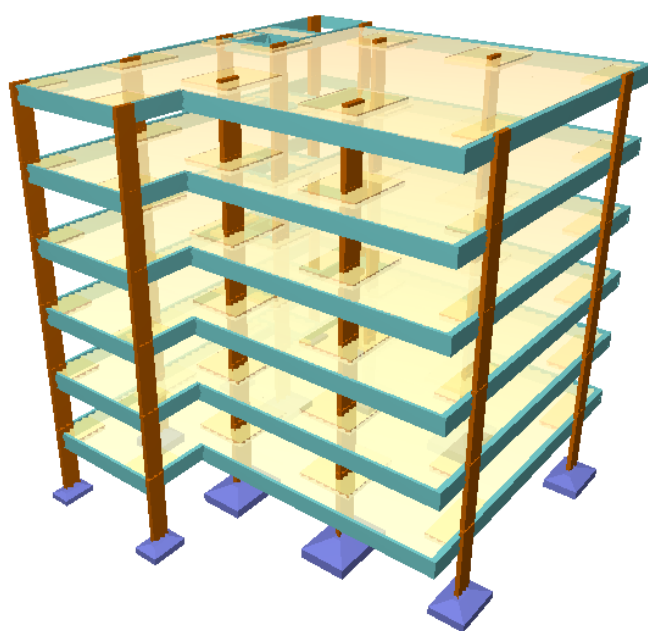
Estrutura 3D do edifício analisado no Estudo de Caso 2 considerando sistema estrutural de lajes nervuradas lisas com utilização de vigas de borda.
